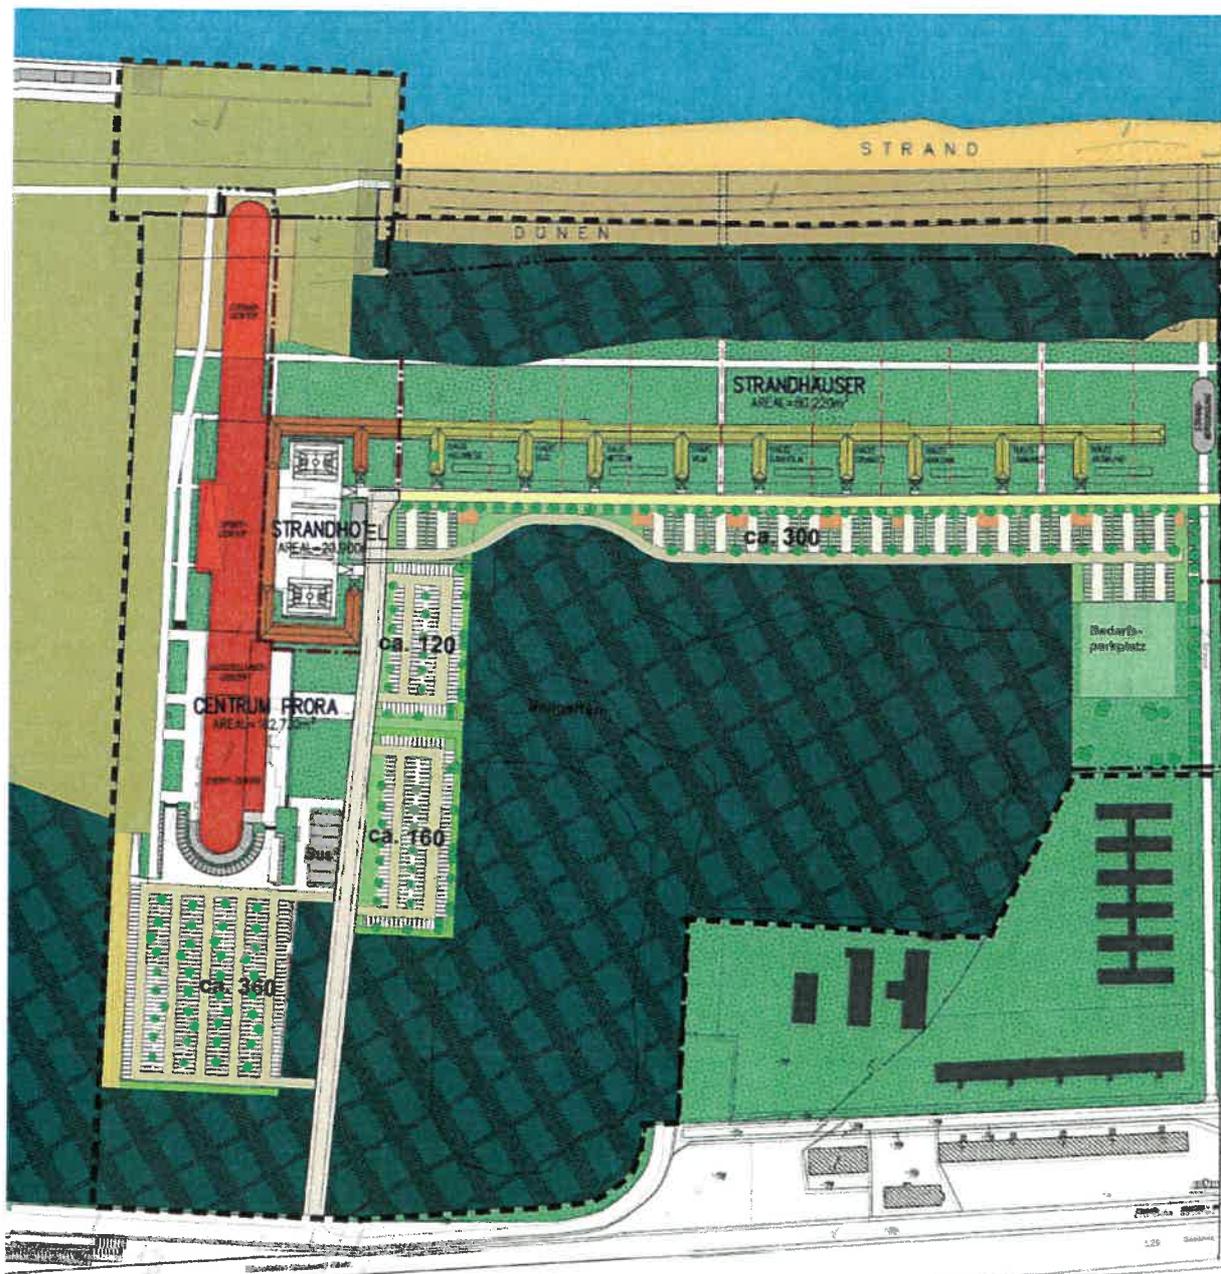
Städtebaulicher Lageplan mit schematischer Anordnung der Parkierung, Stand 02/2013, HRS Architekten / Raith Hertelt Fuß
